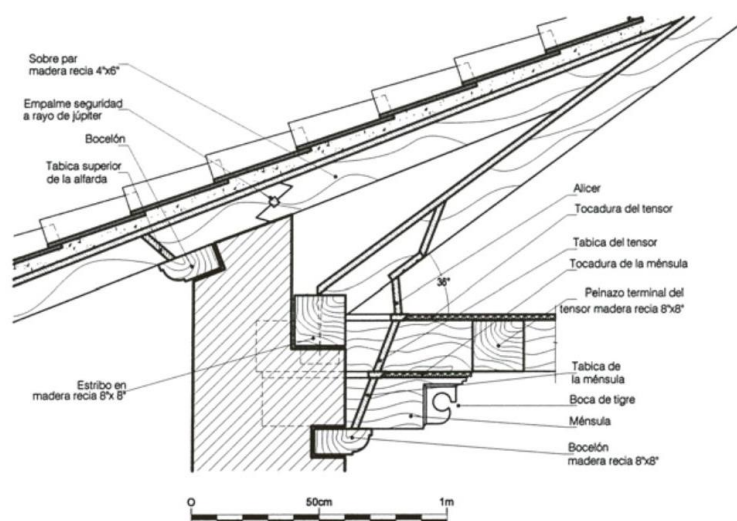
Conformación y elementos constructivos de arquitectura colonial.
